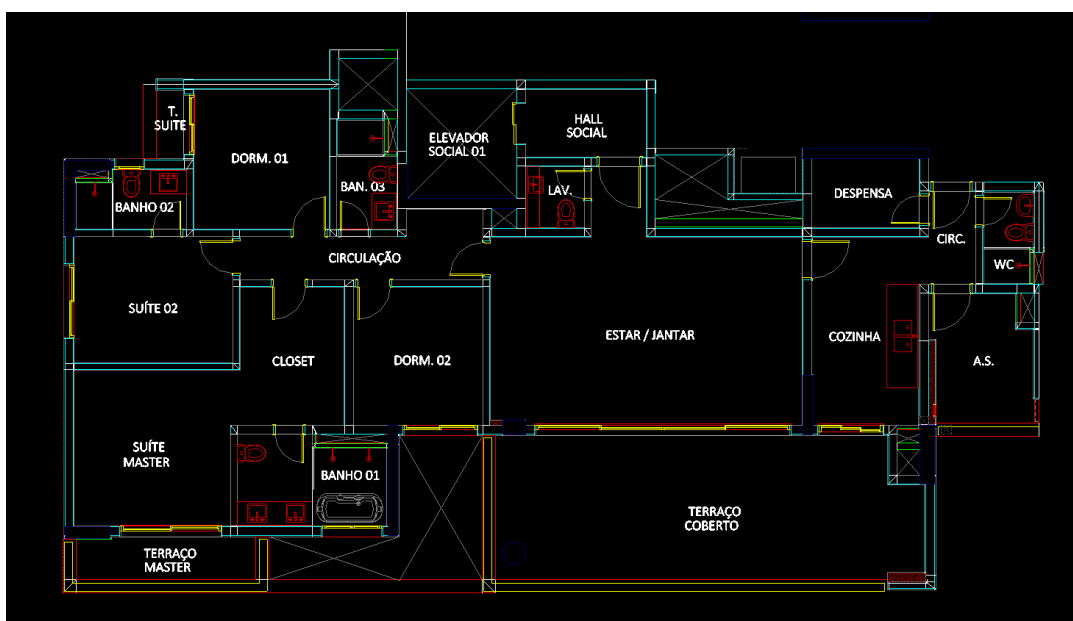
Planta Baixa do pavimento tipo das Torres A e B
